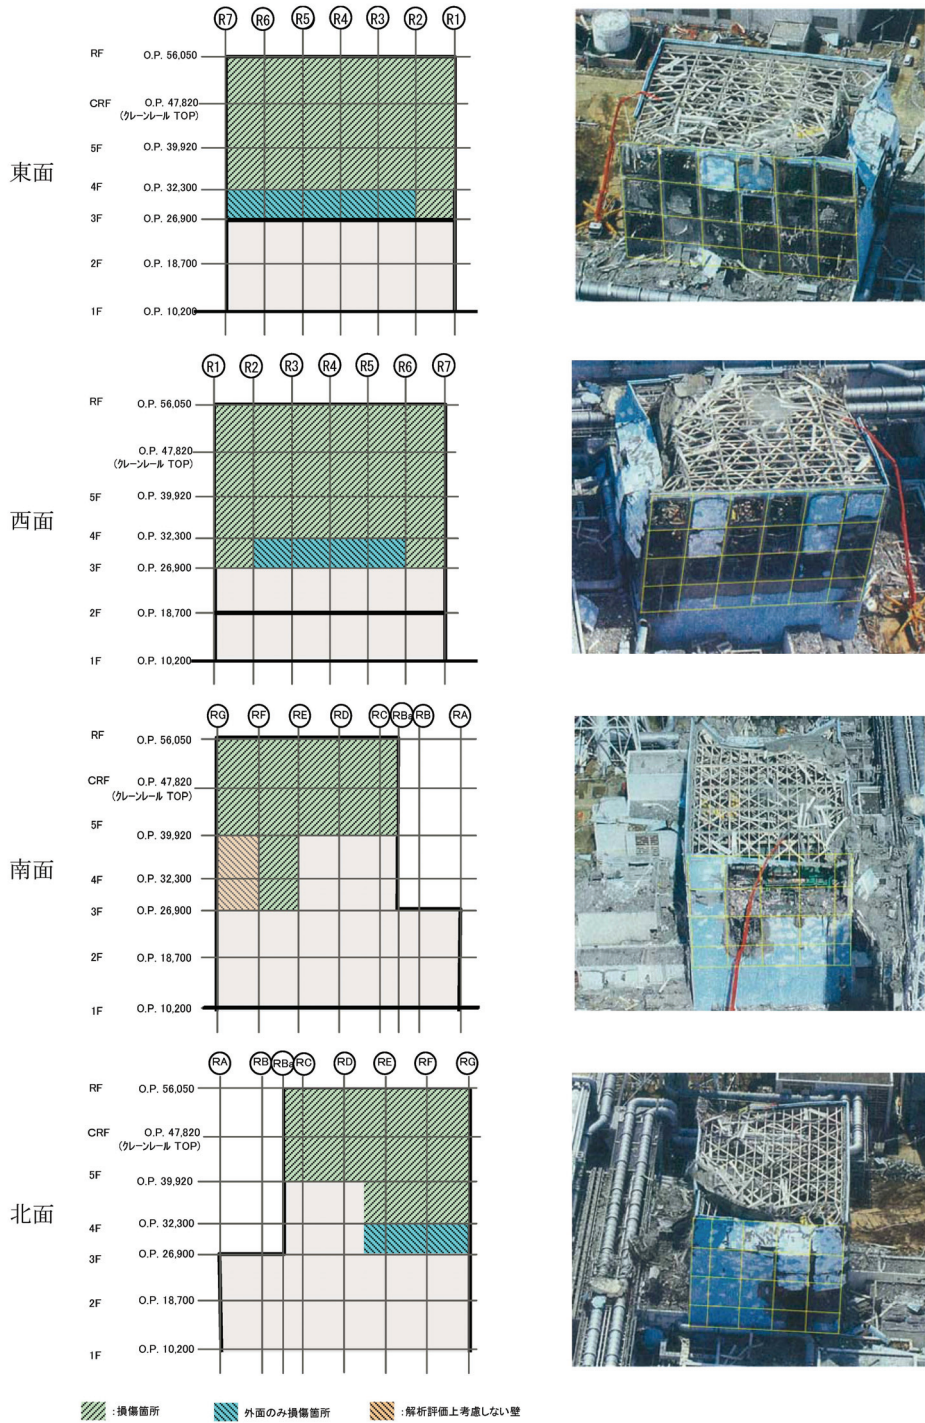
4号機原子炉建屋の損傷状況（立面図）
